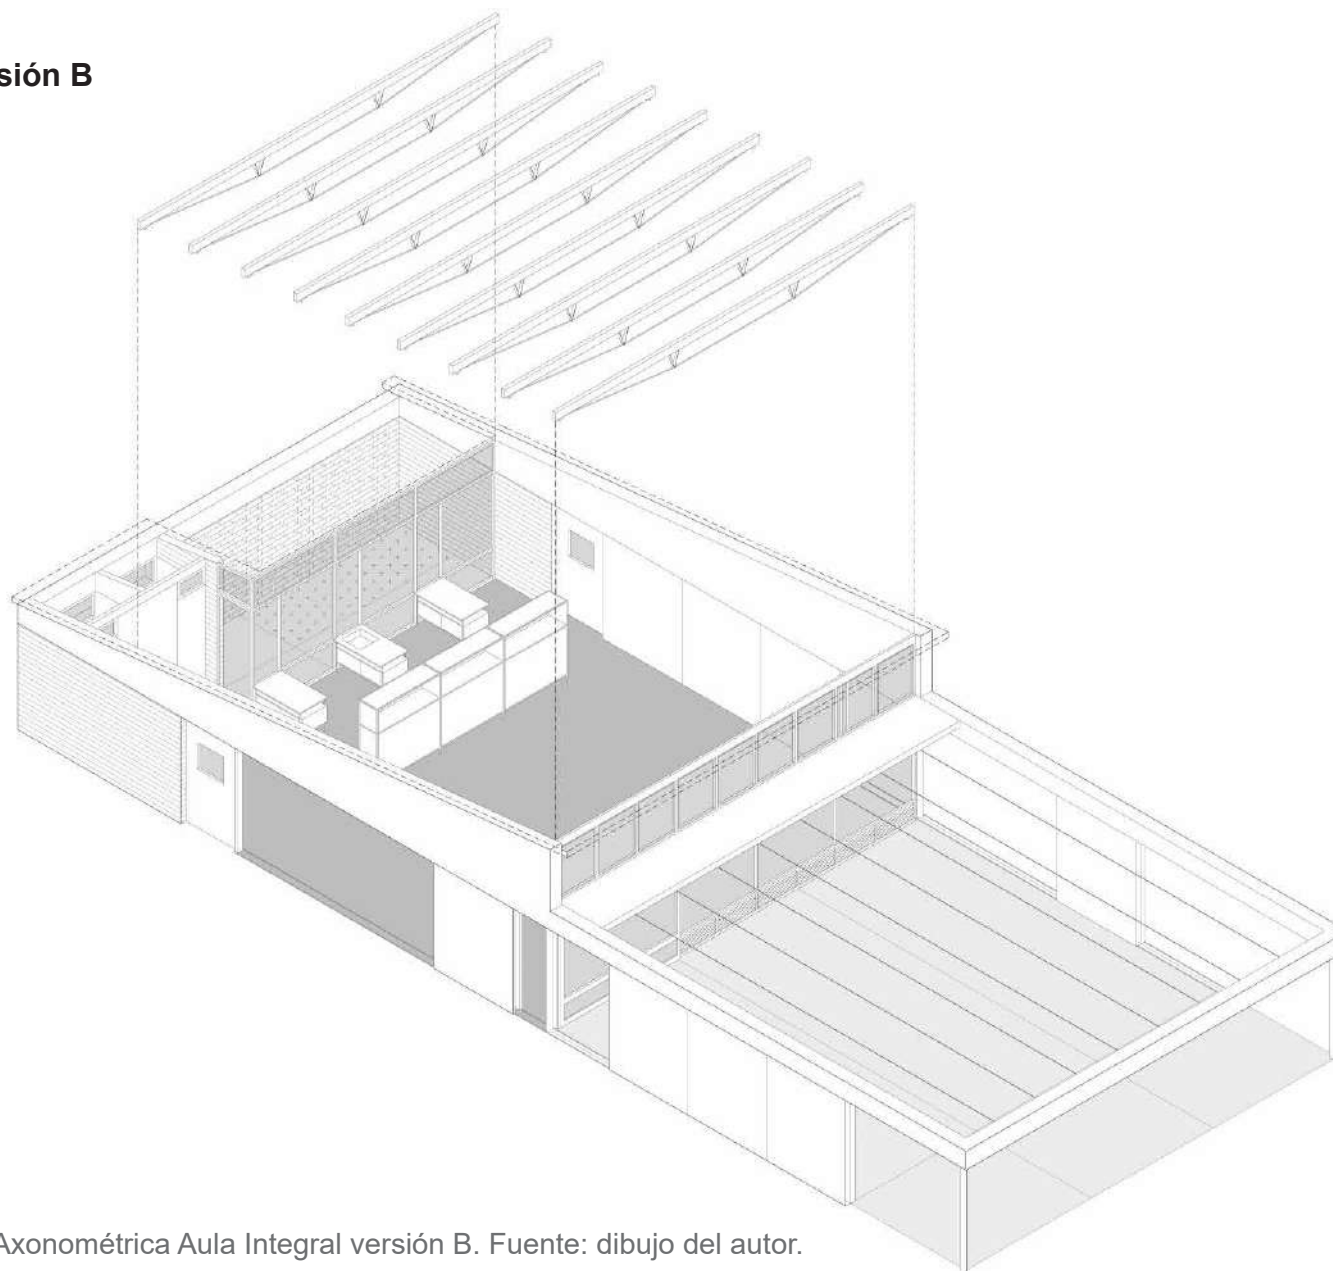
Axonométrica Aula Integral versión B. Fuente: dibujo del autor.
